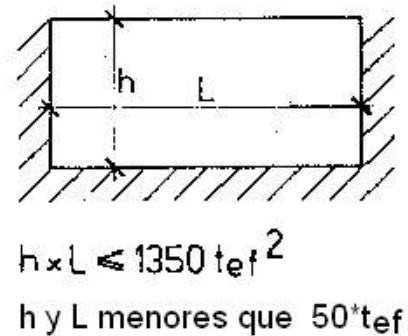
Muro con tres apoyos – Resto de los casos.
